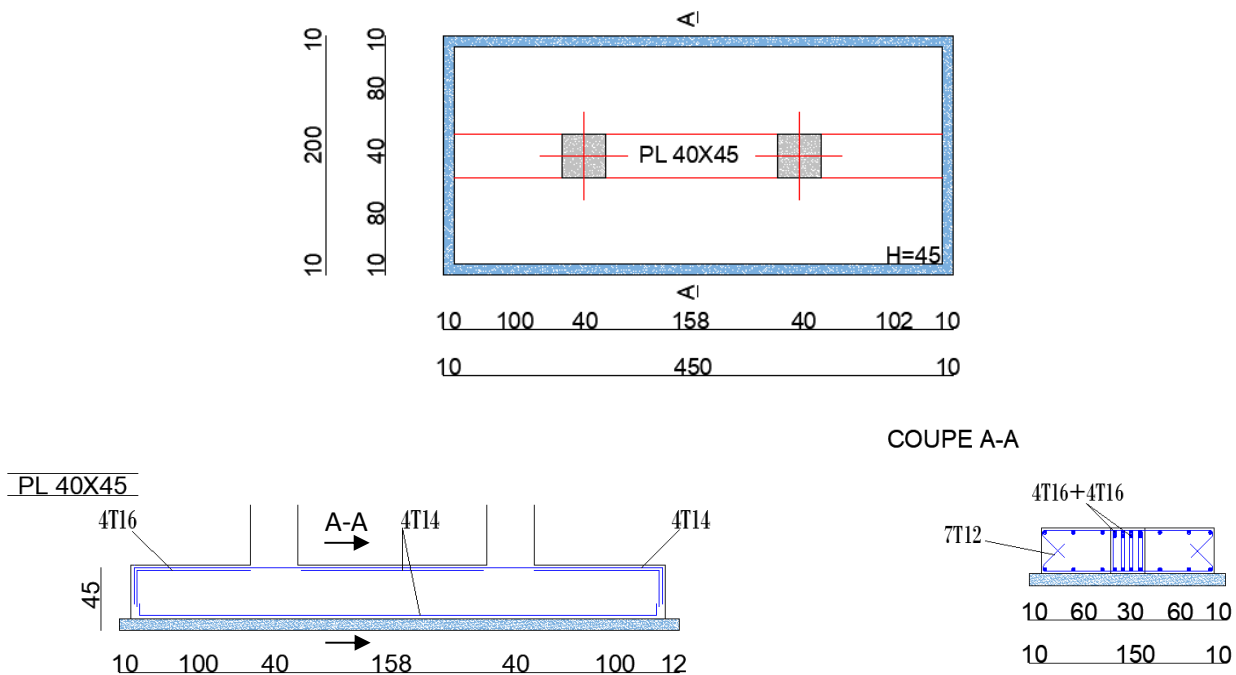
Schéma de ferrailage de Semelle jumelles (450x200x45) cm et de ferrailage de poutre libage
